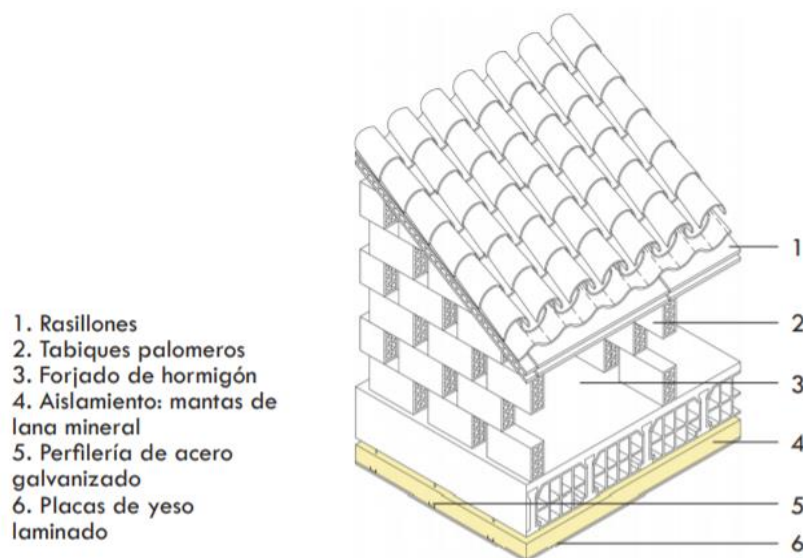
Detalle dunha cuberta con illamento colocado baixo o forxado horizontal<sup>61</sup>
